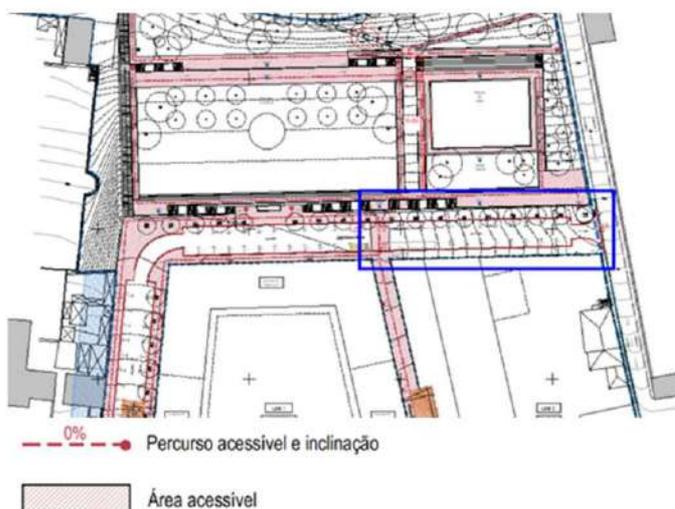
Plano de Acessibilidades - Planta Geral (desenho LOT-022, Julho 2022).
